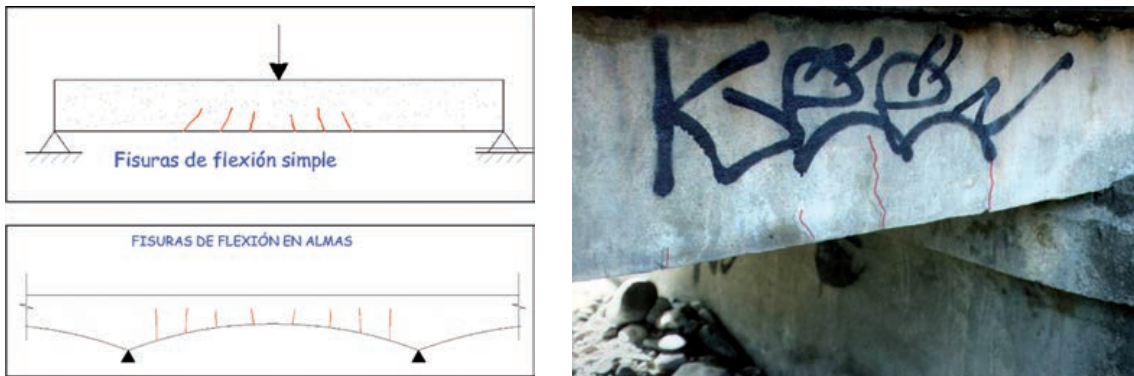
ESQUEMAS DE FISURACIÓN POR ESFUERZOS.
